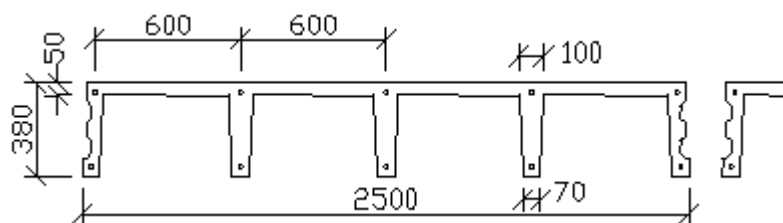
Coupe longitudinale d'un élément préfabriqué de dalle
